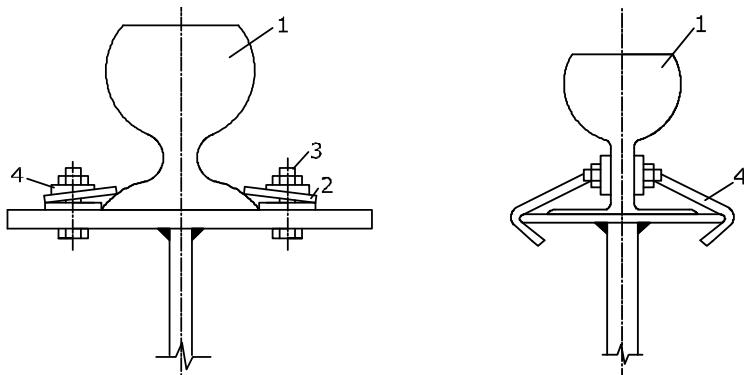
Схемы крепления подкрановых рельсов к балкам:
